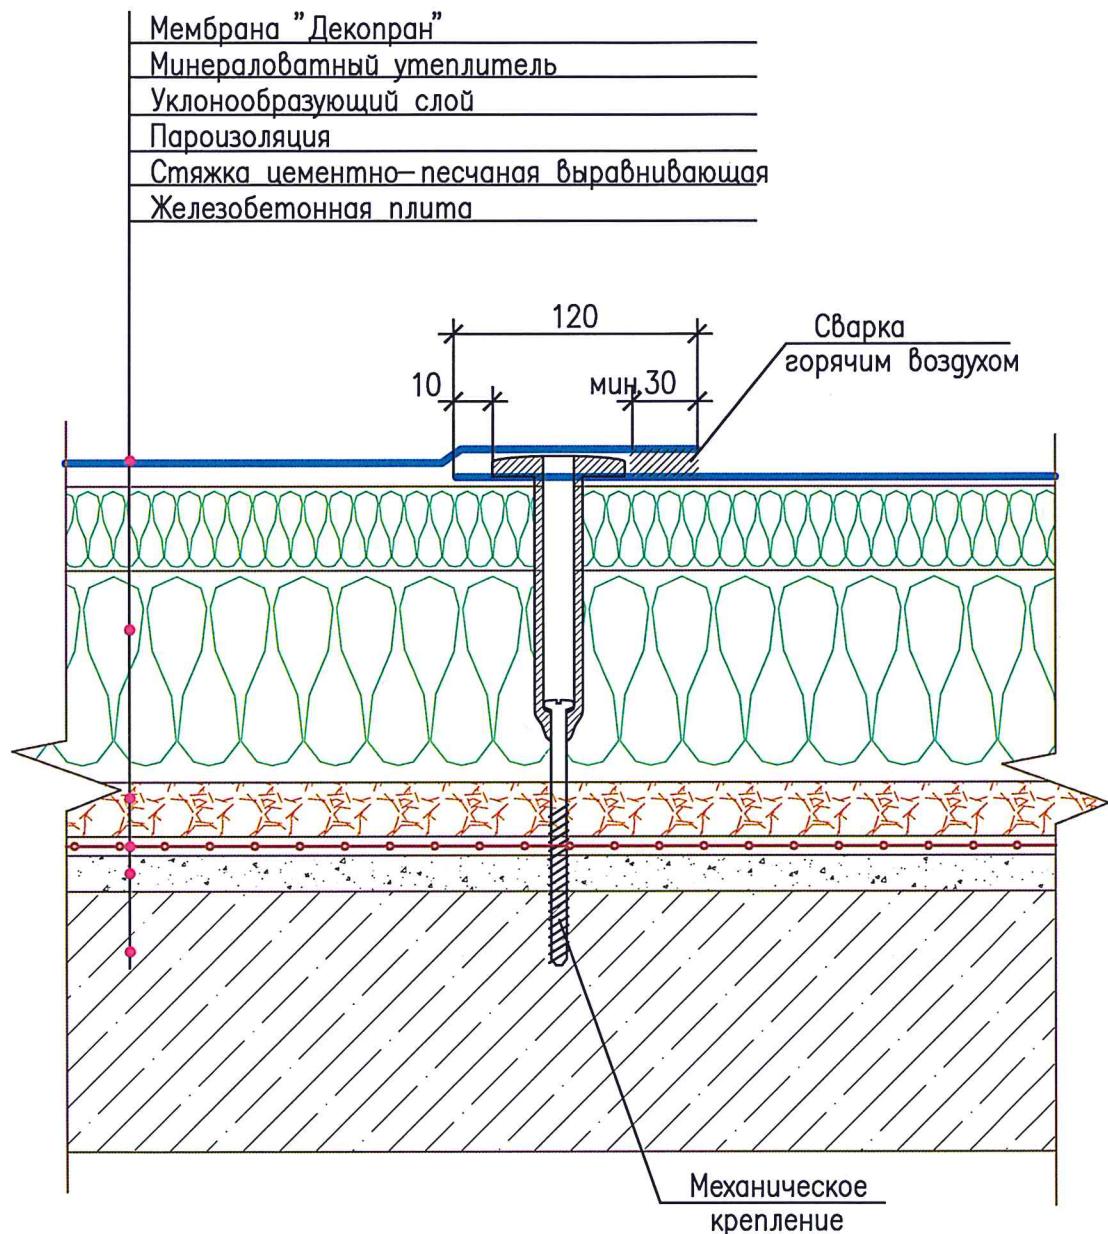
Механическое закрепление к железобетонному основанию. Структура покрытия
